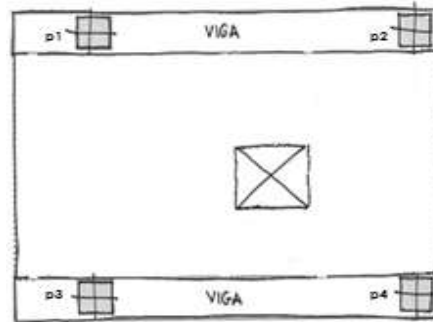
Forjado unidireccional con los pórticos que lo componen.
